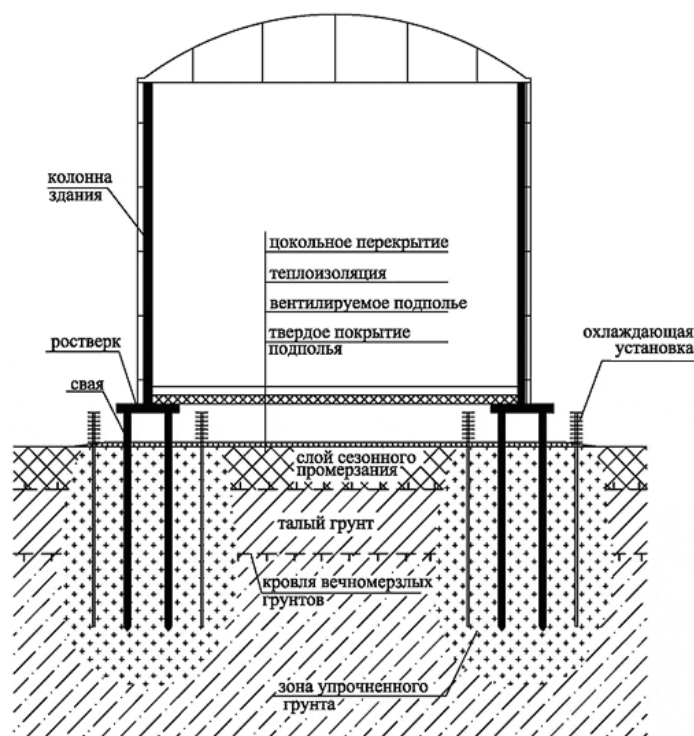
Фундамент мелкозаложенного здания с опорой на кровлю вечномерзлых грунтов при обеспечении принципа строительства и эксплуатации
